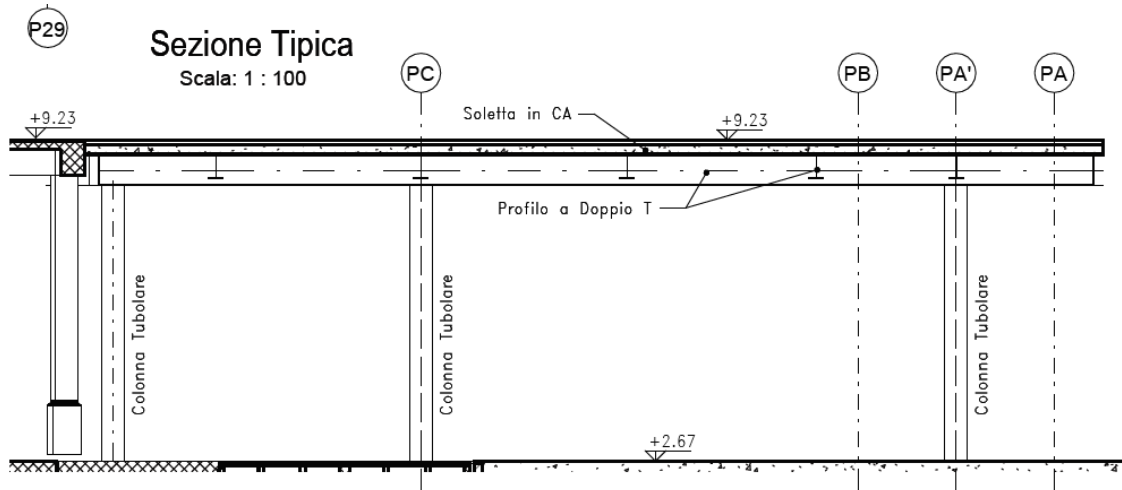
Stato di Progetto sezione tipo strutturale lungo la terrazza esistente
